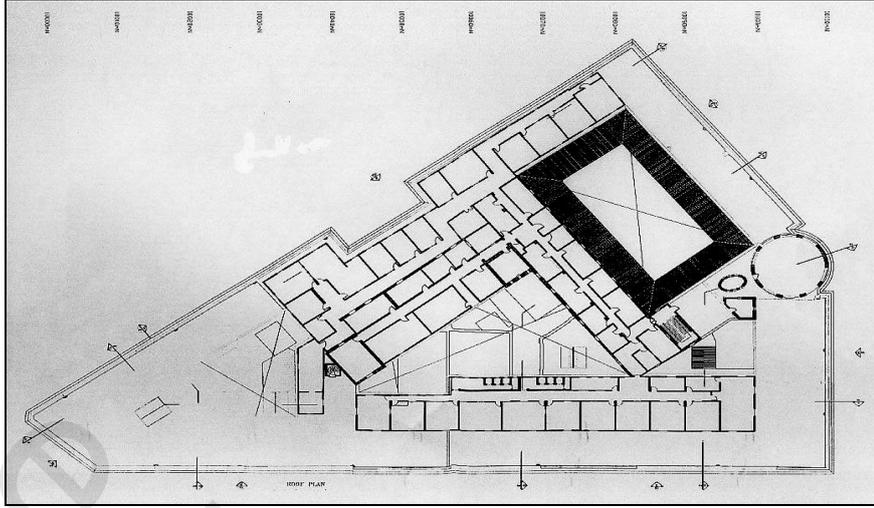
المسقط الأفقى للدور الأرضى أو الأول وبه توزيع القاعات
